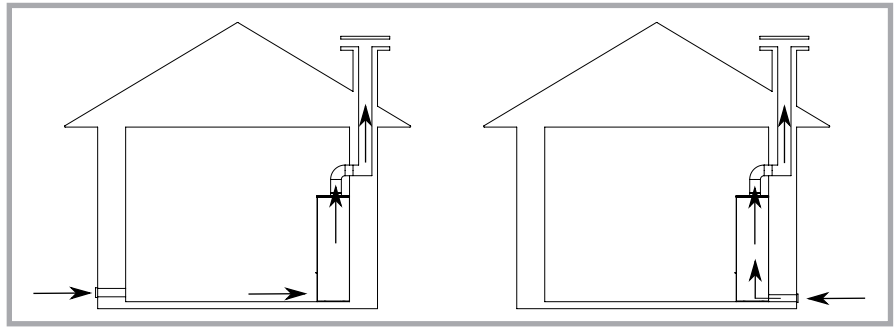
Installazione mediante presa d'aria nel locale e installazione con presa d'aria esterna collegata direttamente alla stufa a legna.
